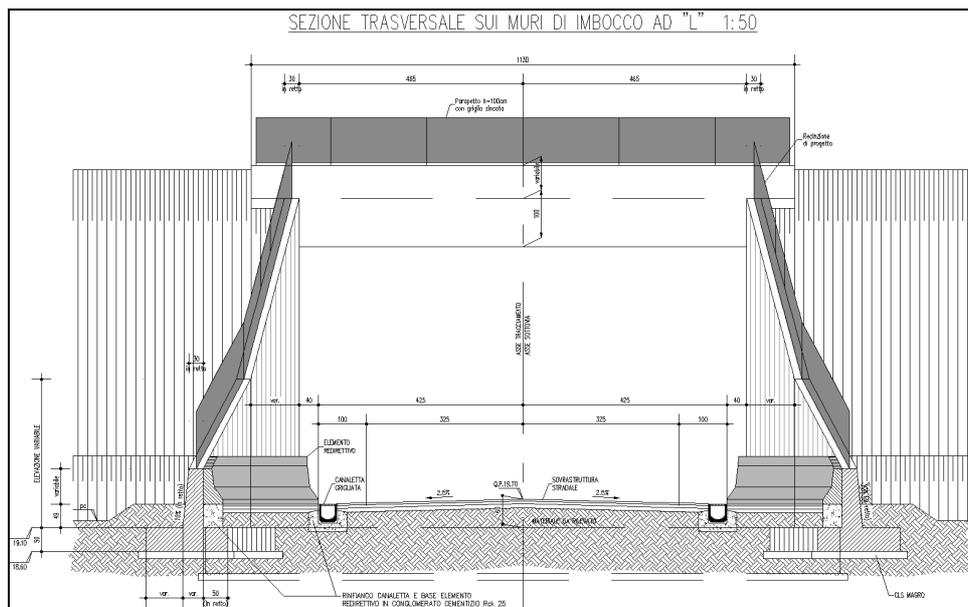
SEZIONE TRASVERSALE SUI MURI DI IMBOCCO AD "L"
